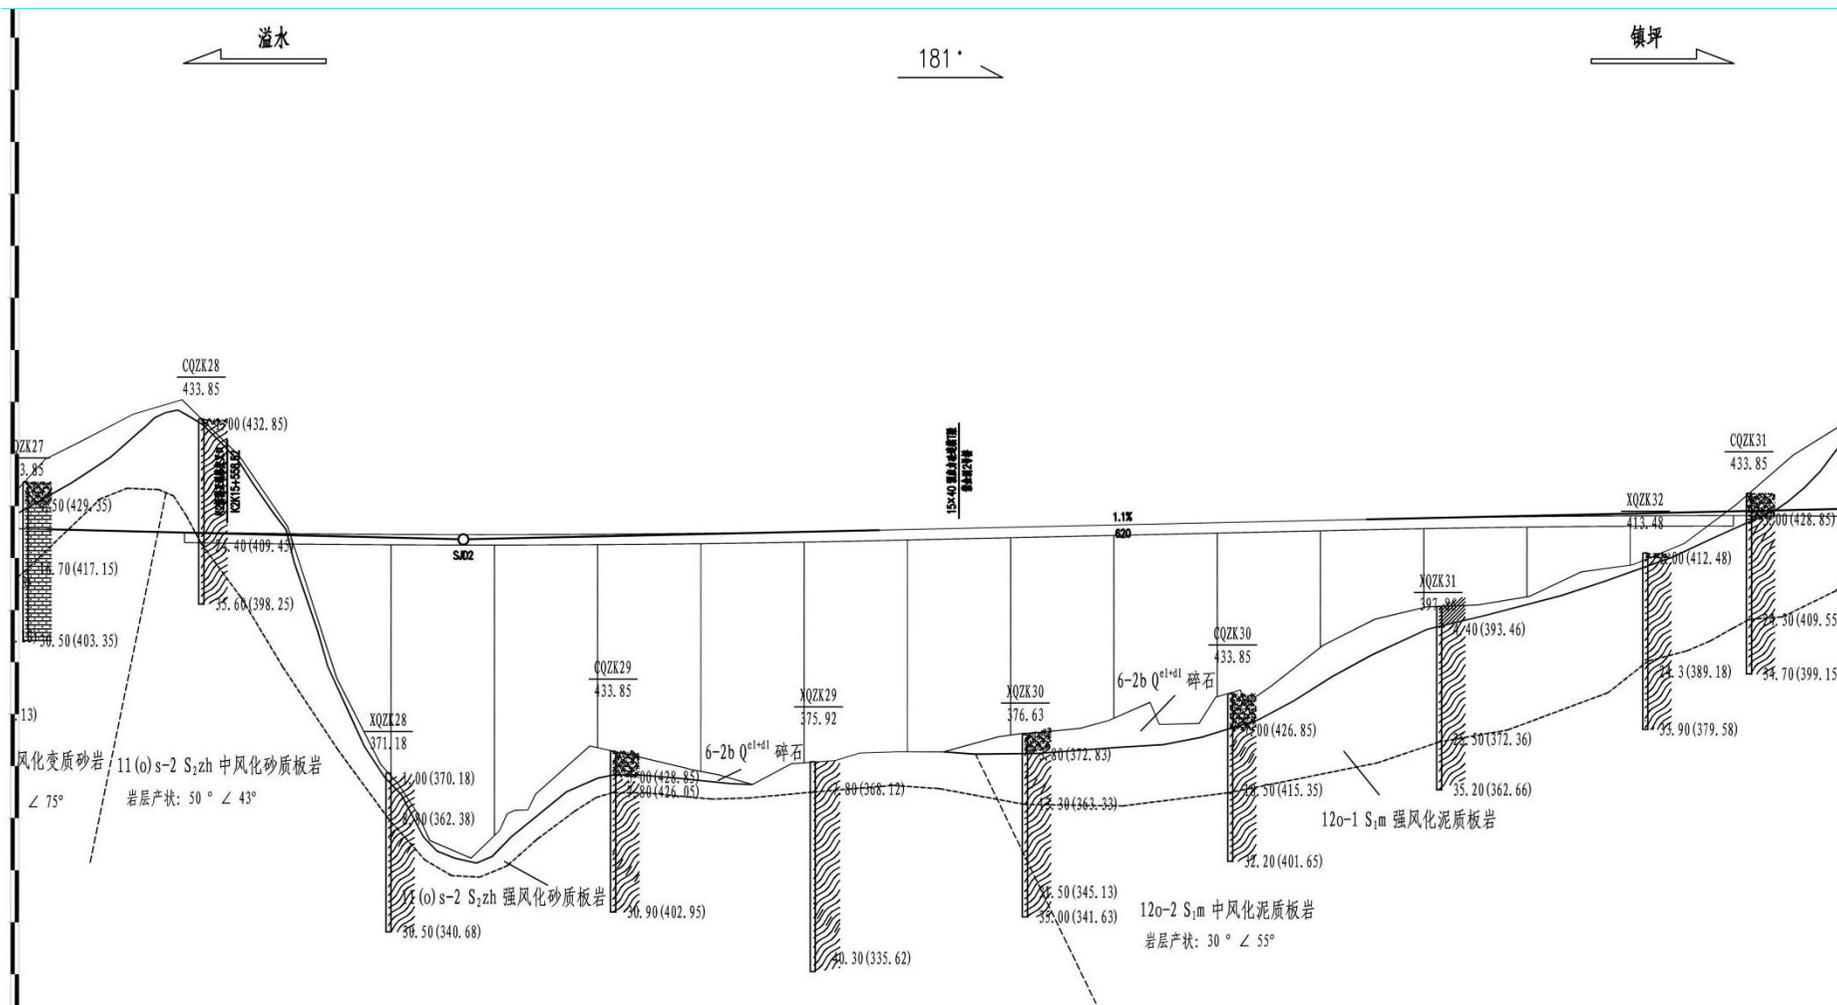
紫金洞 2 号大桥桥址区地质纵断面图
